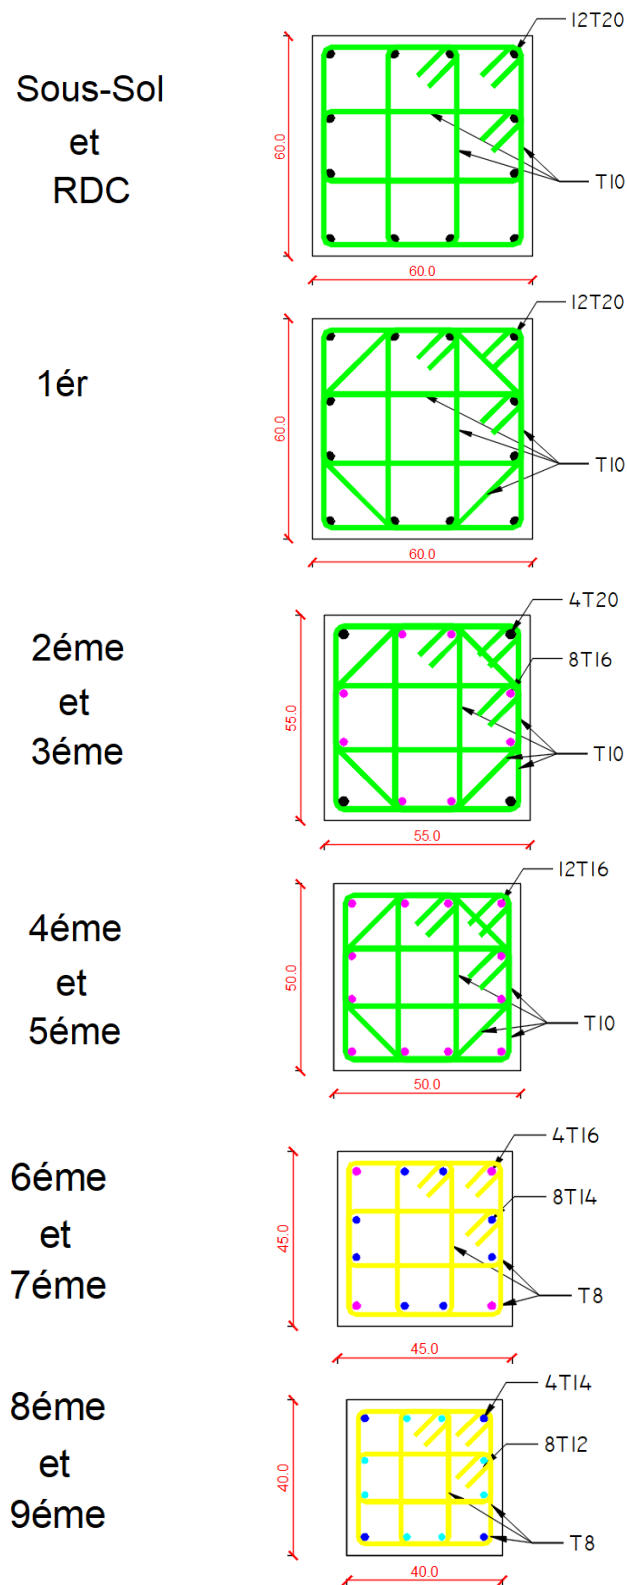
Schéma de ferrailage des poteaux zone courante.
